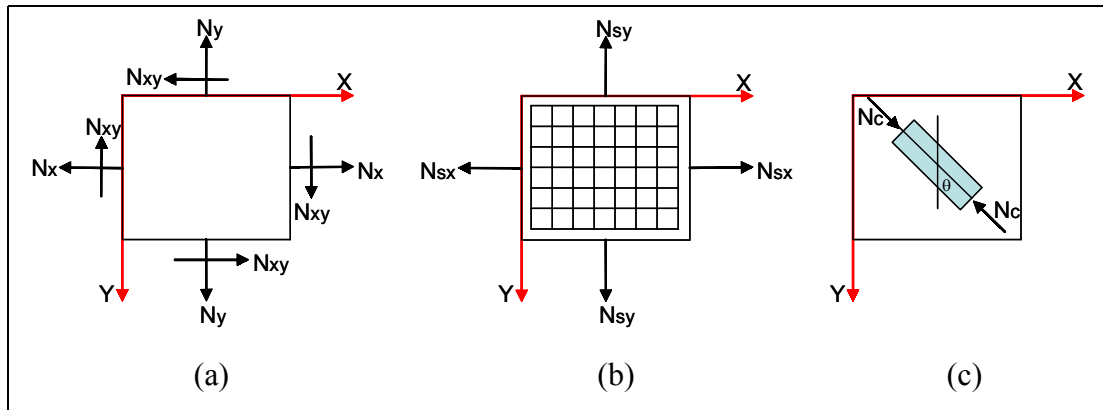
Elemento de concreto submetido a estado plano de tensões: (a) elemento de chapa submetido a forças de membrana, (b) contribuição das armaduras e (c) contribuição do concreto
